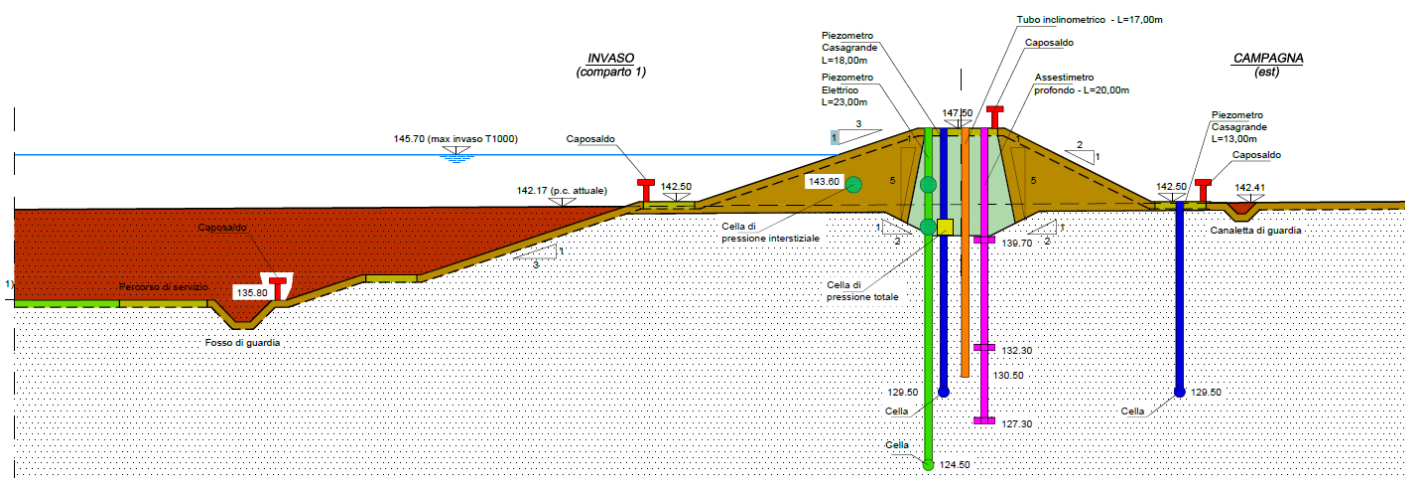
Schema d'ubicazione della strumentazione per il monitoraggio (Sezione tipo 4)
